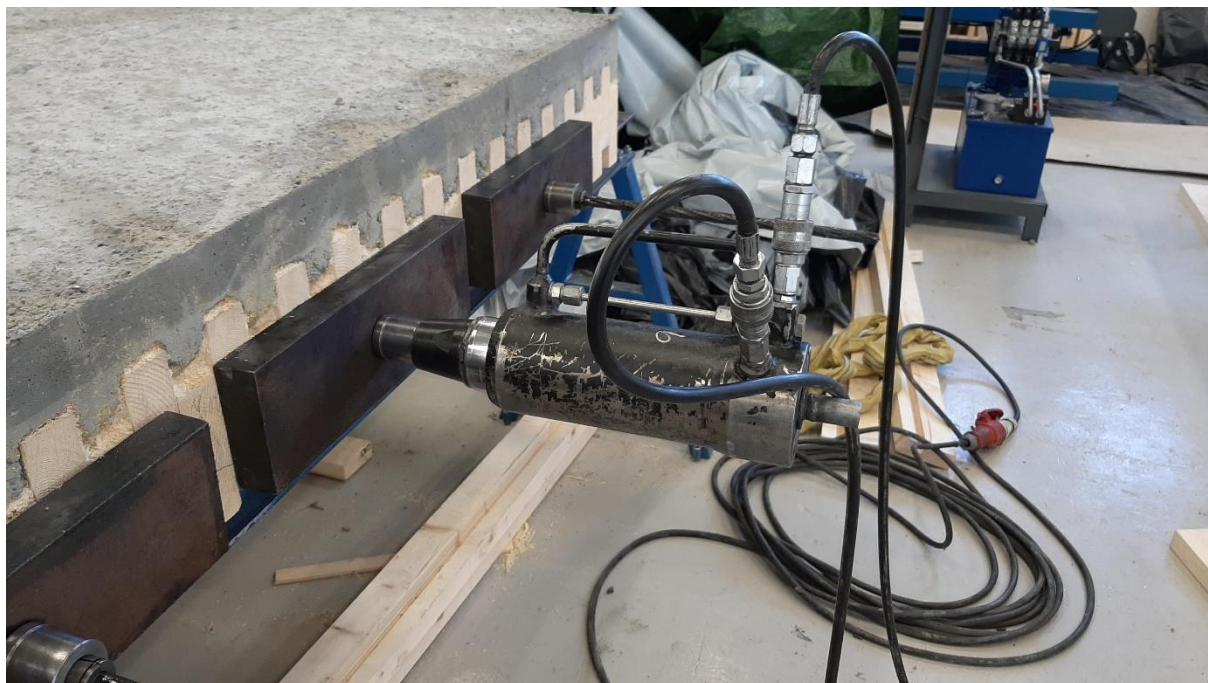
Montering av stålplater, hylser og kiler.
